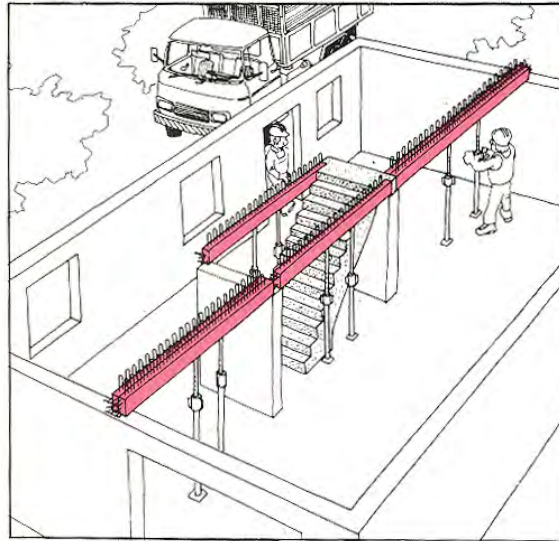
APOYO DE TRABES SOBRE COLUMNAS Y DE VIGUETA Y BOVEDILLA SOBRE TRABES
